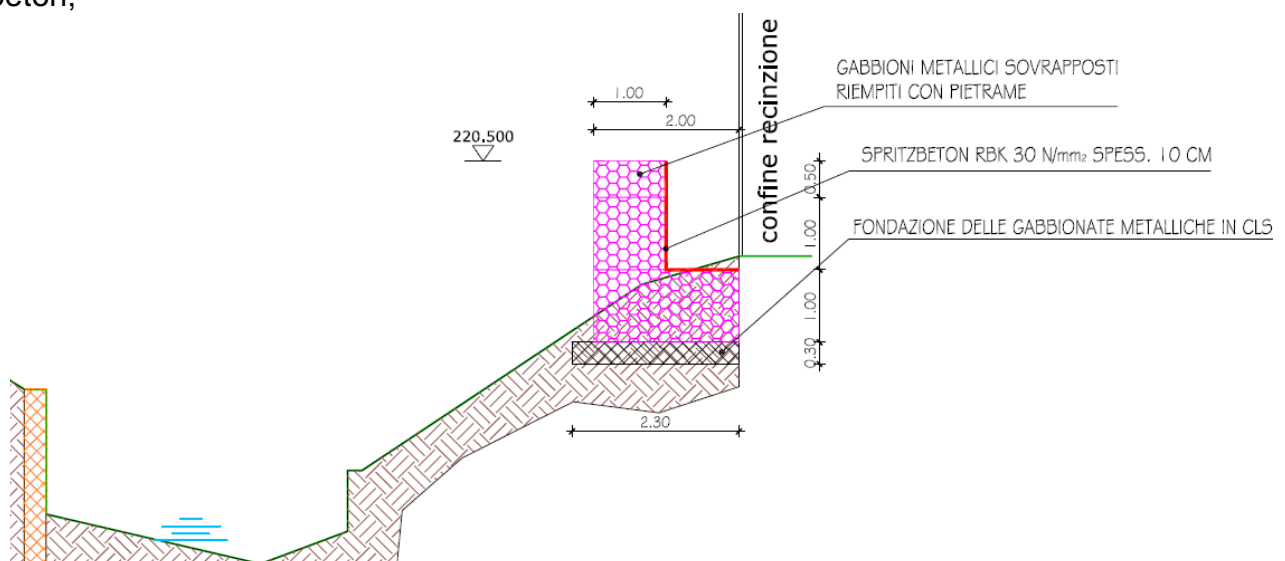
Sezione tipo dei gabbioni, tratto 1
